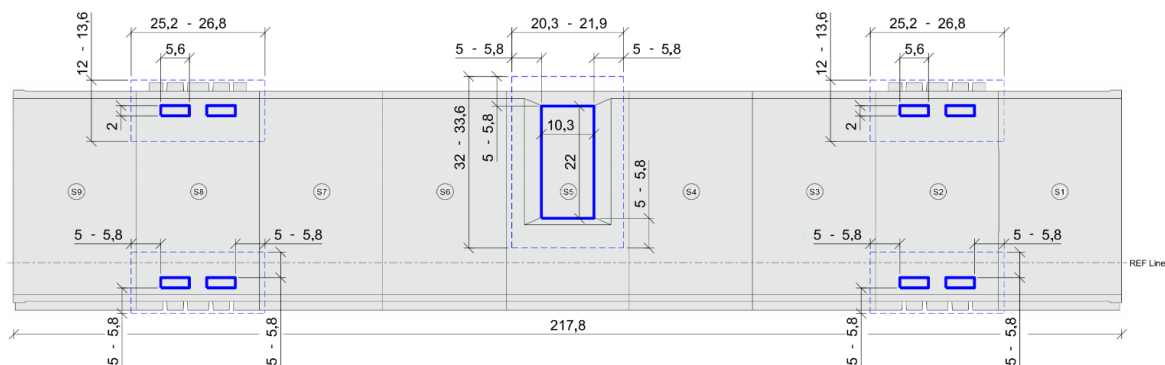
Schematische Darstellung eines Standard-Tunnelements (STE) bestehend aus neun Segmenten - Aufsicht. Durchgezogene blaue Linien: Obere Ränder der Ventilationsnischen (Segment S5) und Haltestützen (Segmente S2 und S8). Gestrichelte blaue Linien: Ränder der über diesen Bauteilen liegenden Schutzschicht (Längen in m). Die genaue Abmessung der Schutzschichtüberdeckungen hängt von der jeweils eingesetzten Steinklasse ab (daher die Wertespannen in der Bemaßung).
